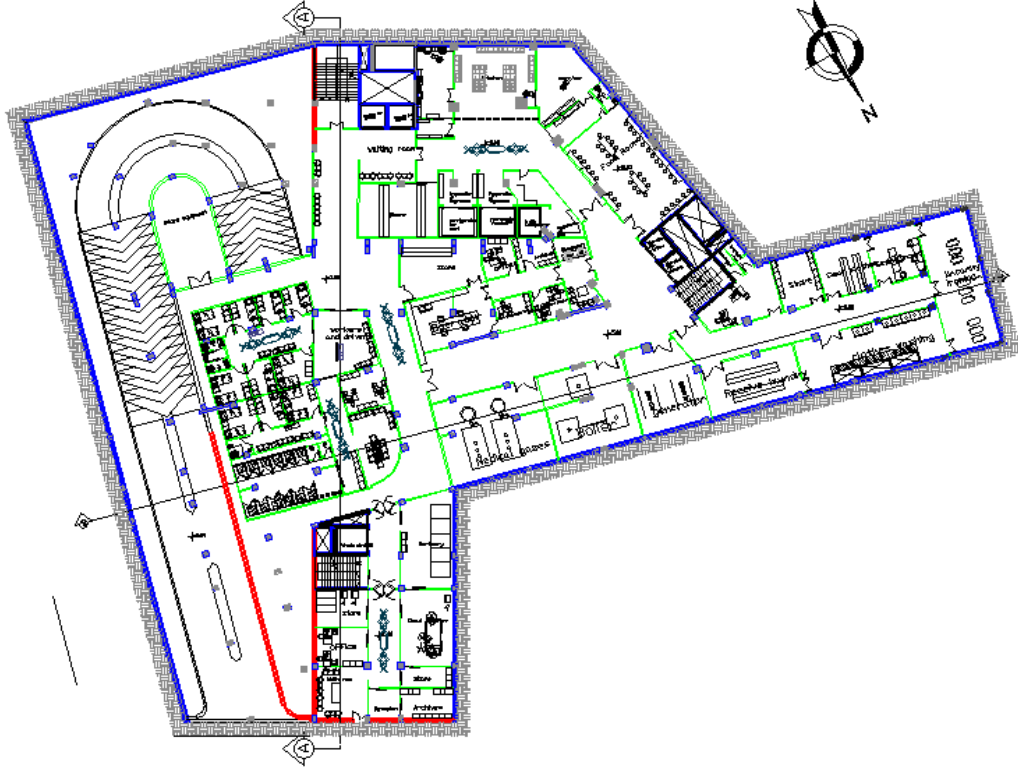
المسقط الأفقي لطابق التسوية الثاني
